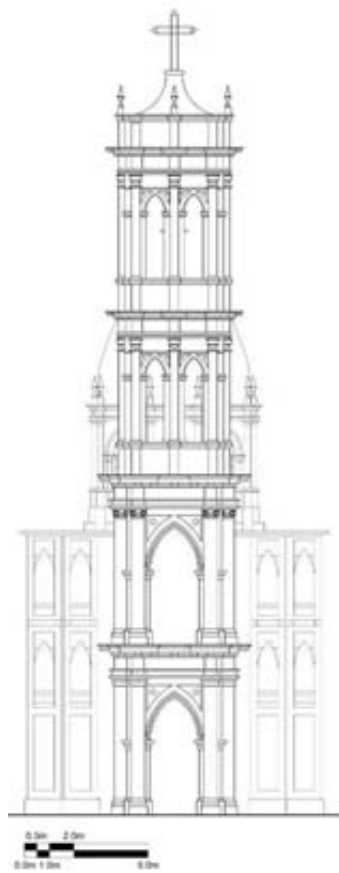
, 175 y 176. Fachada poniente, fachada oriente y vista de la Parroquia de San Pedro Apóstol en Senguio. Foto archivo JGGB.
